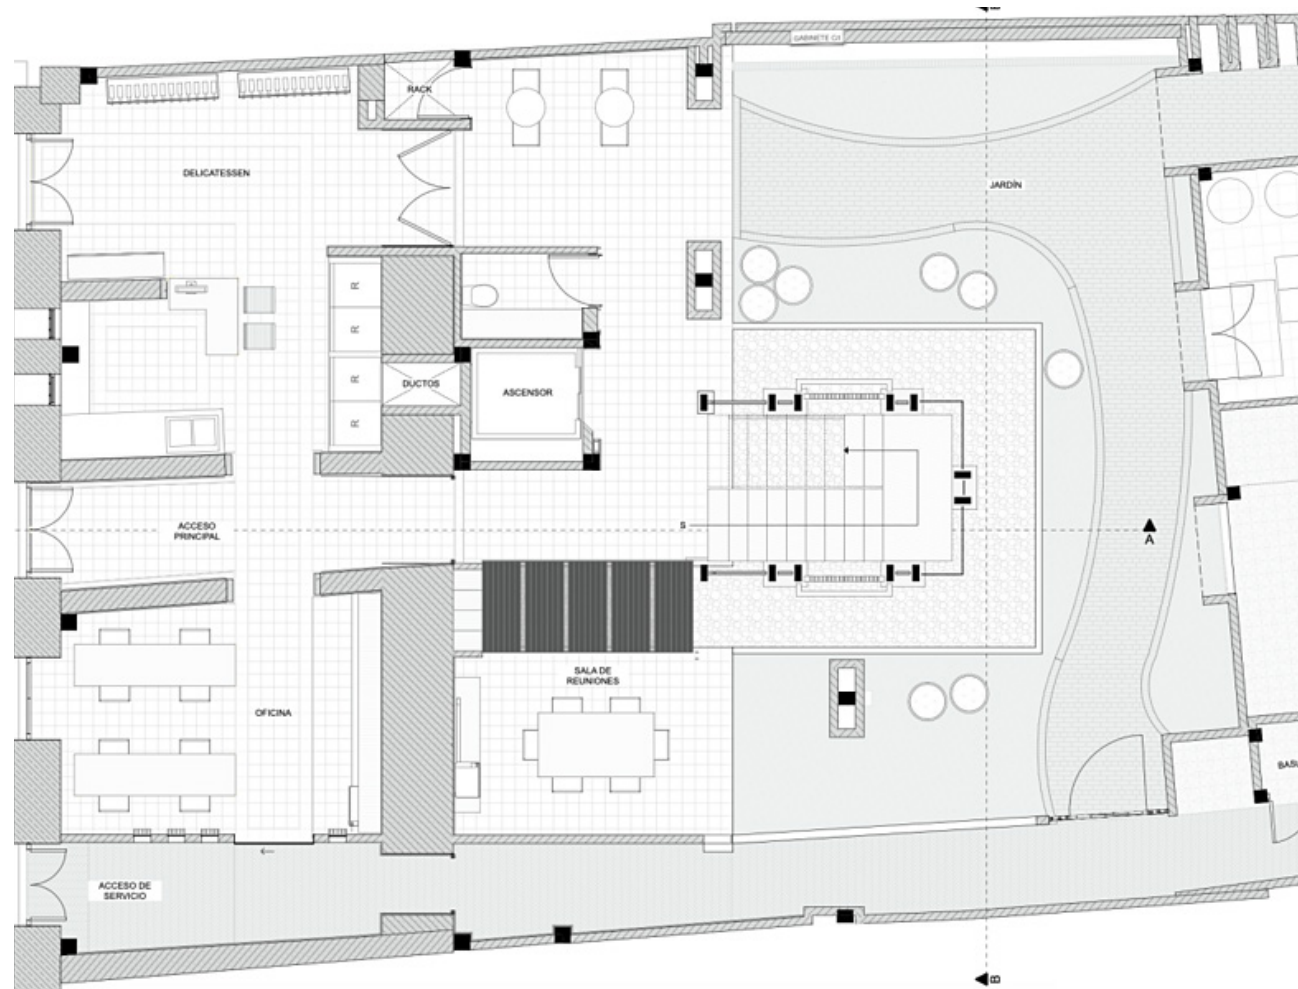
Planta intervención Hotel Reales de Alcázar.
